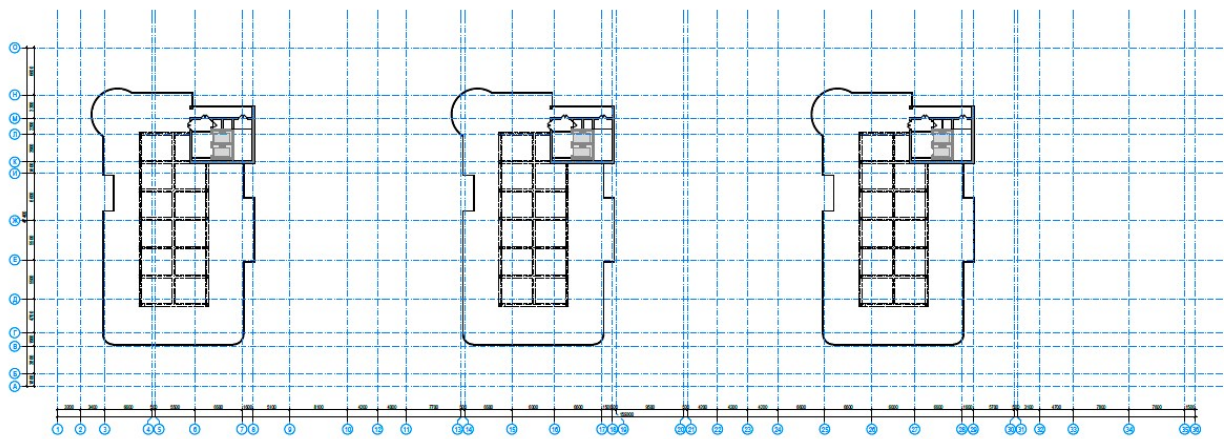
План п'ятого поверху М1:200 на відмітці +13,500
